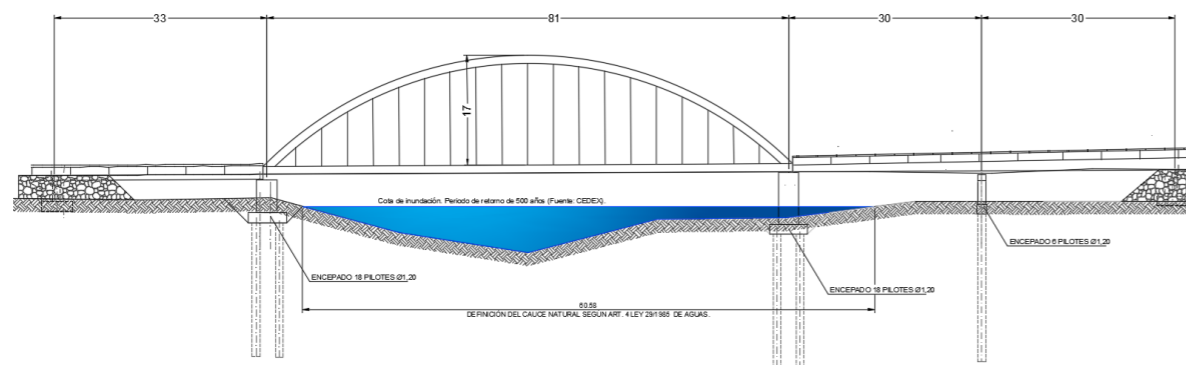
Alzado de la estructura de cruce del Río Júcar.
